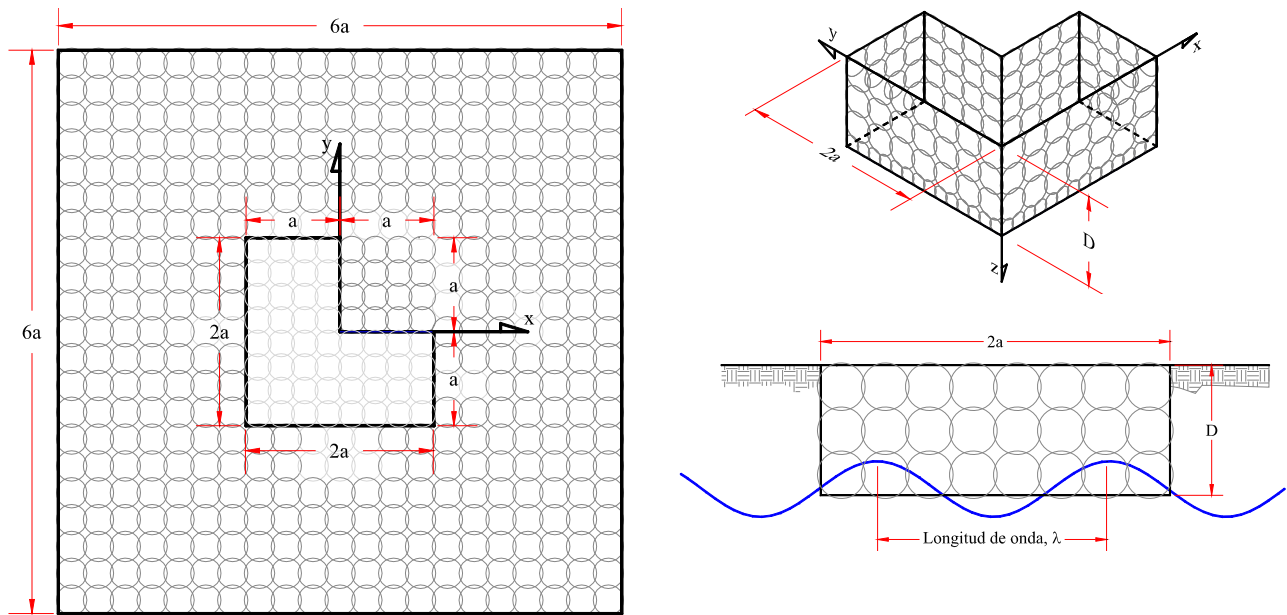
Geometría de la cimentación y discretización de las fronteras con elementos circulares.
